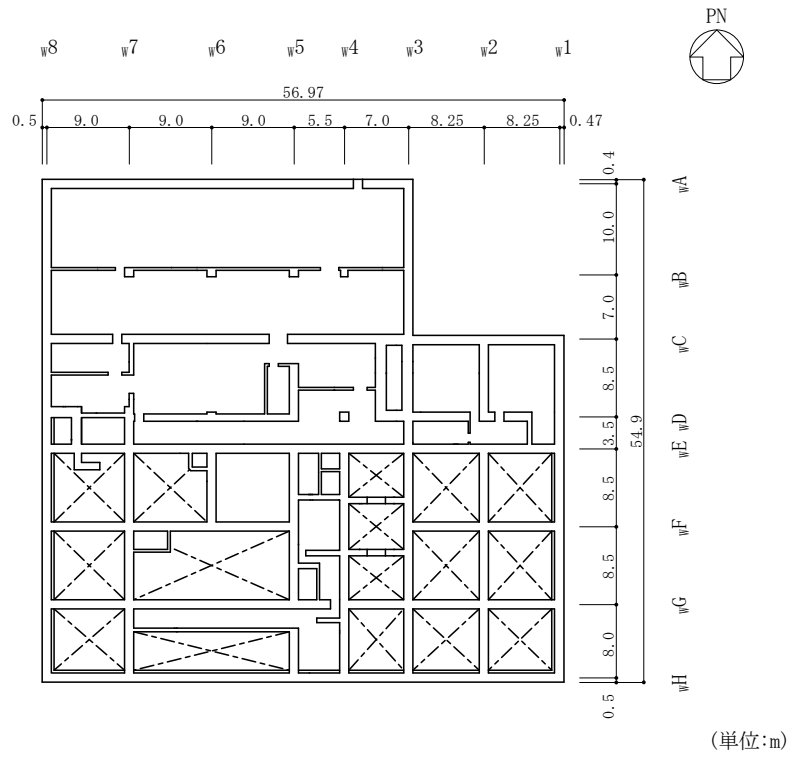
(3) 廃棄物処理建物の概略平面図 (EL 12.3m)
